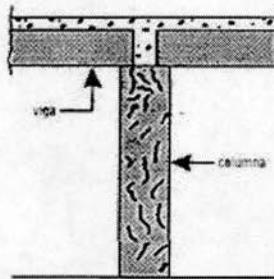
Fisuras de fraguado o falso fraguado
